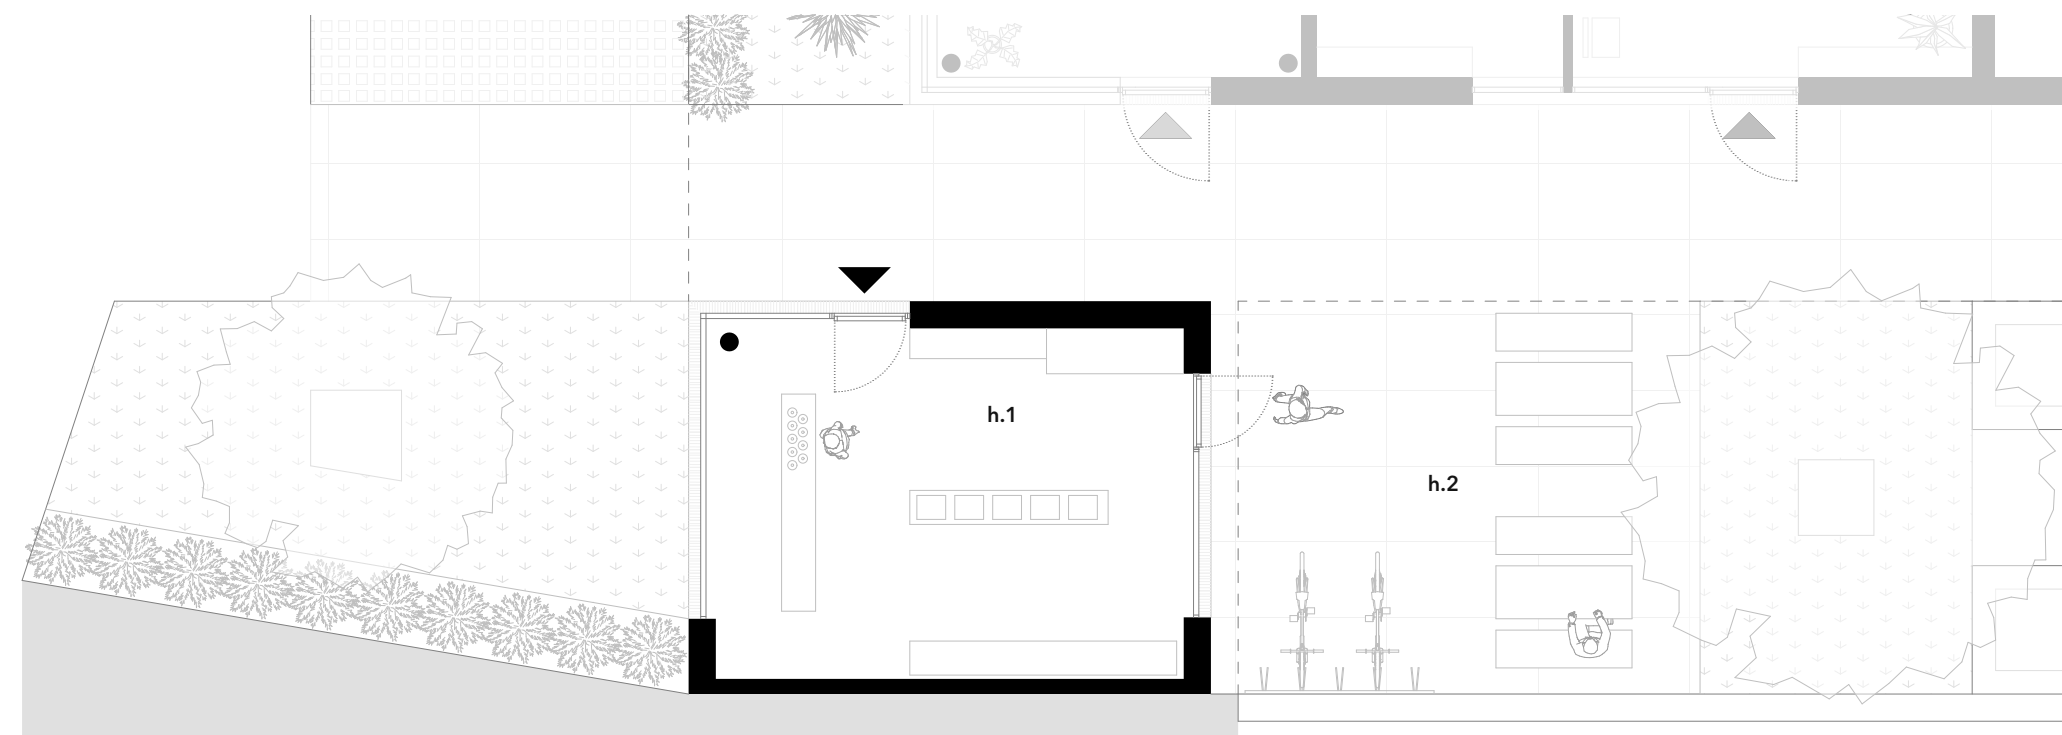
Grundriss Ausschnitt Hofladen
